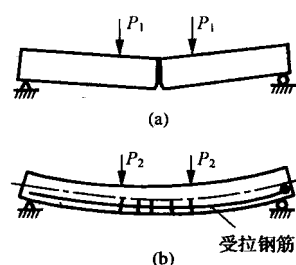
素混凝土梁与钢筋混凝土梁的破坏情况对比
